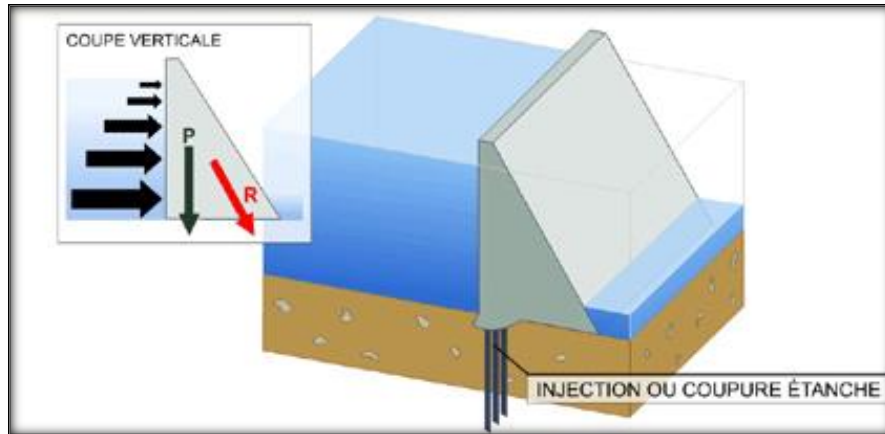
Barrages en béton- type poids (Procèdes généraux de construction des barrages)
